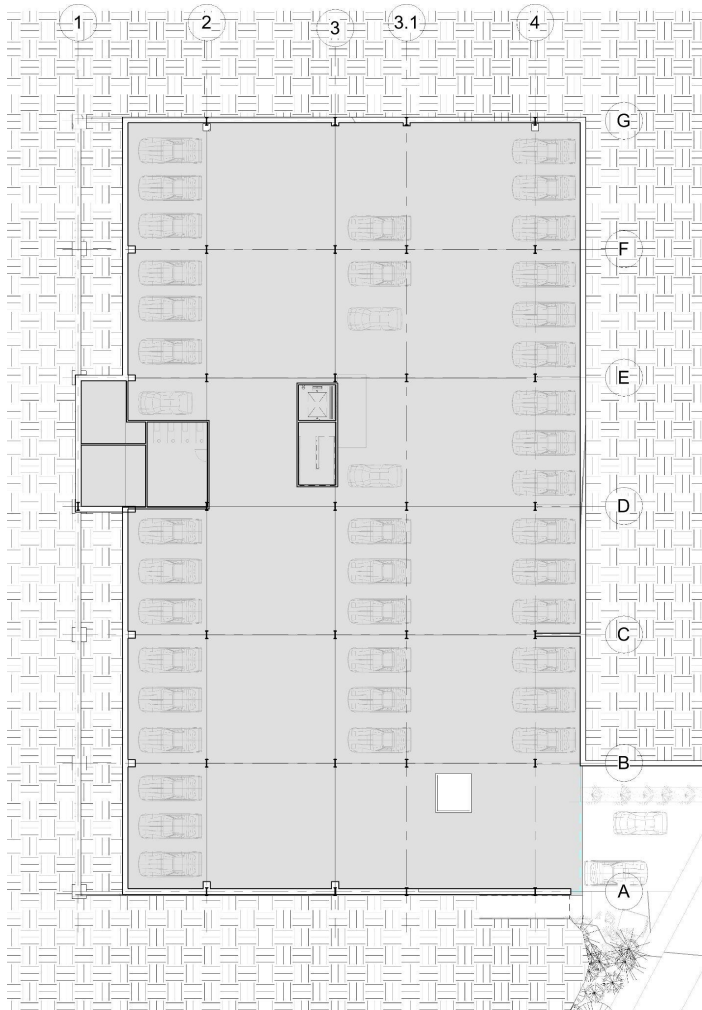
Planta de cielo del sótano. Fuente propia.
